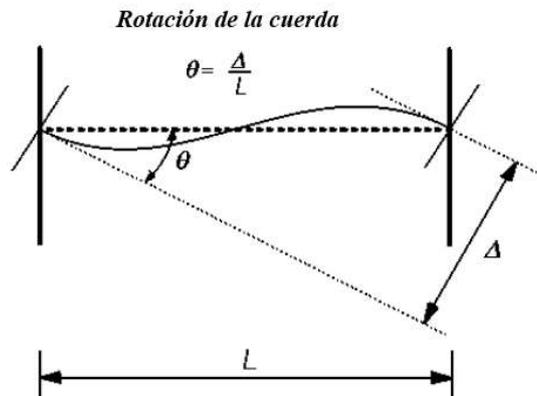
Rotación de viga de acoplamiento entre muros de concreto
